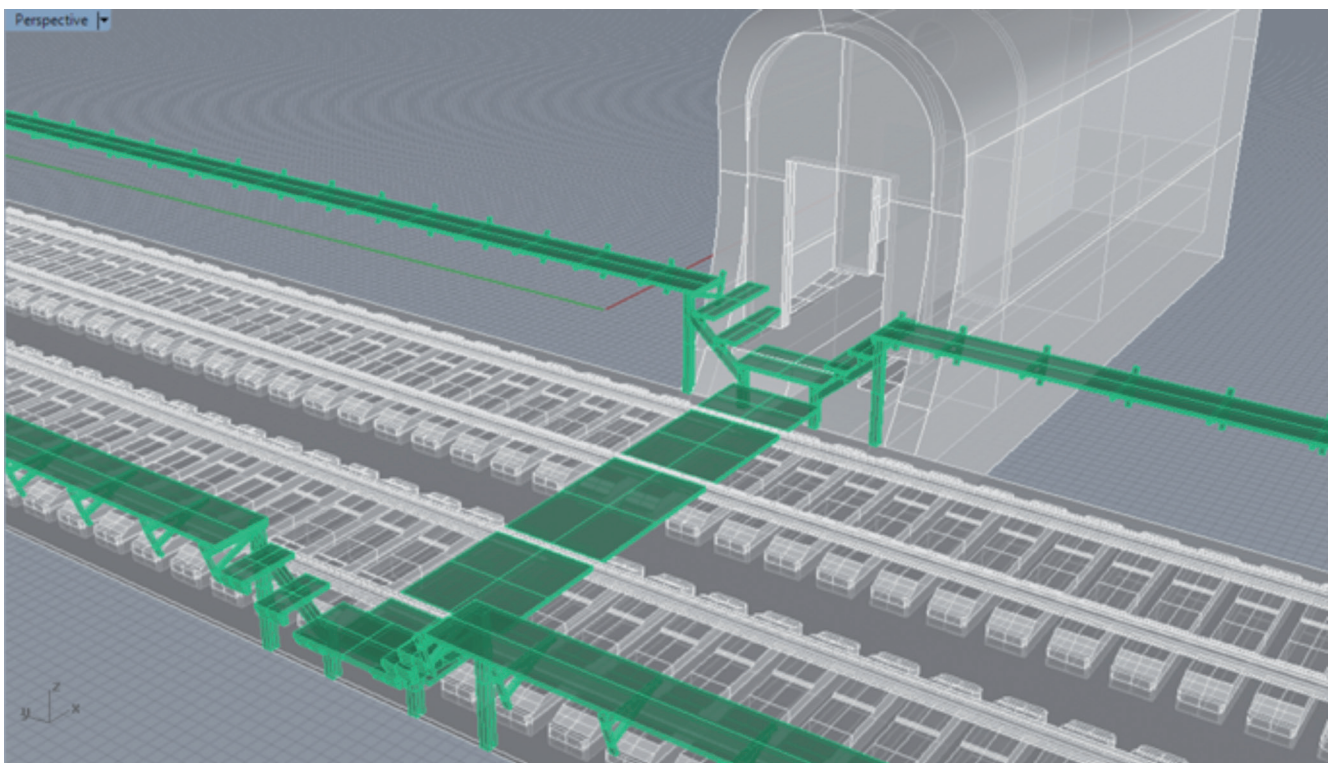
Configuration de la passerelle d'évacuation au droit d'un ouvrage annexe
